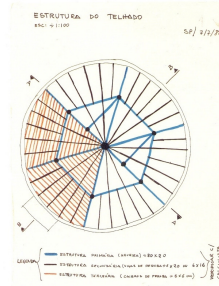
Diagrama da estrutura do telhado da capela.
